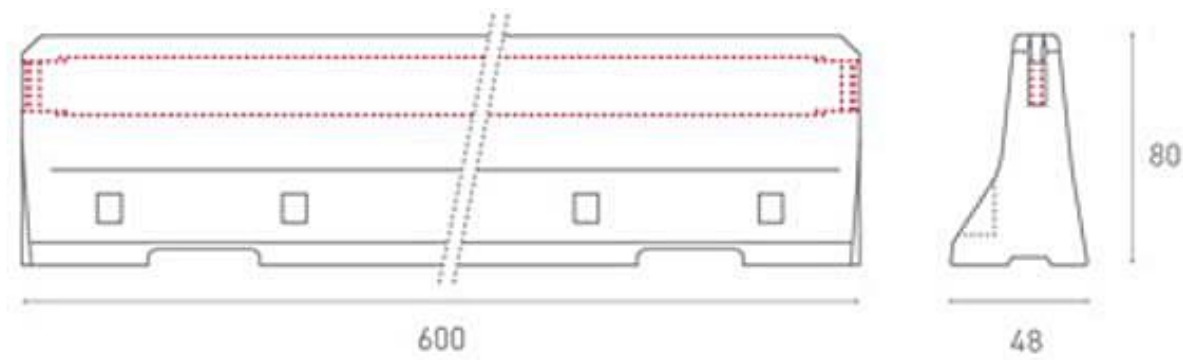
Geometría de la barrera de hormigón del sistema DB 80AS-A
